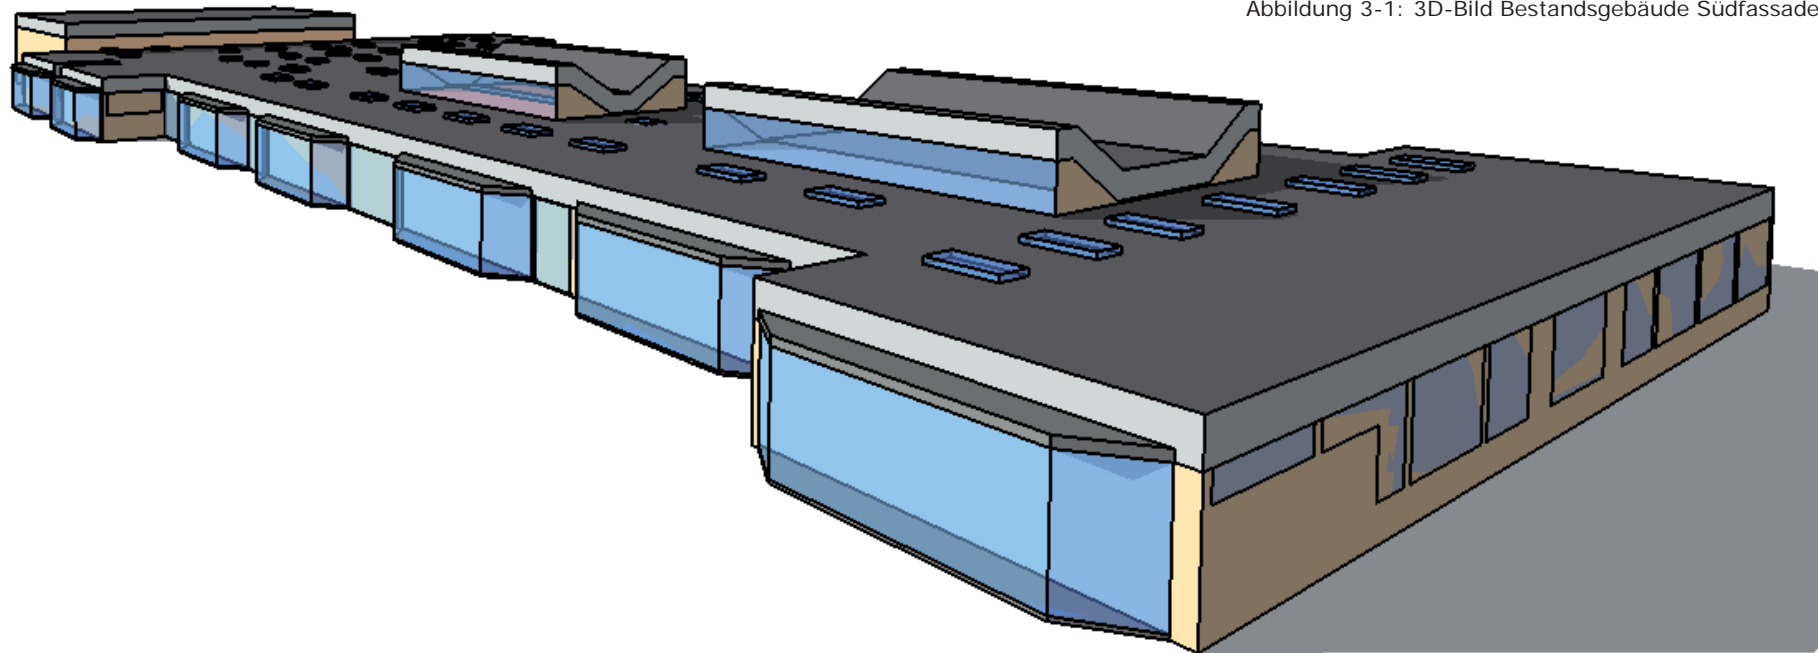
3D-Bild Bestandsgebäude Südfassade
